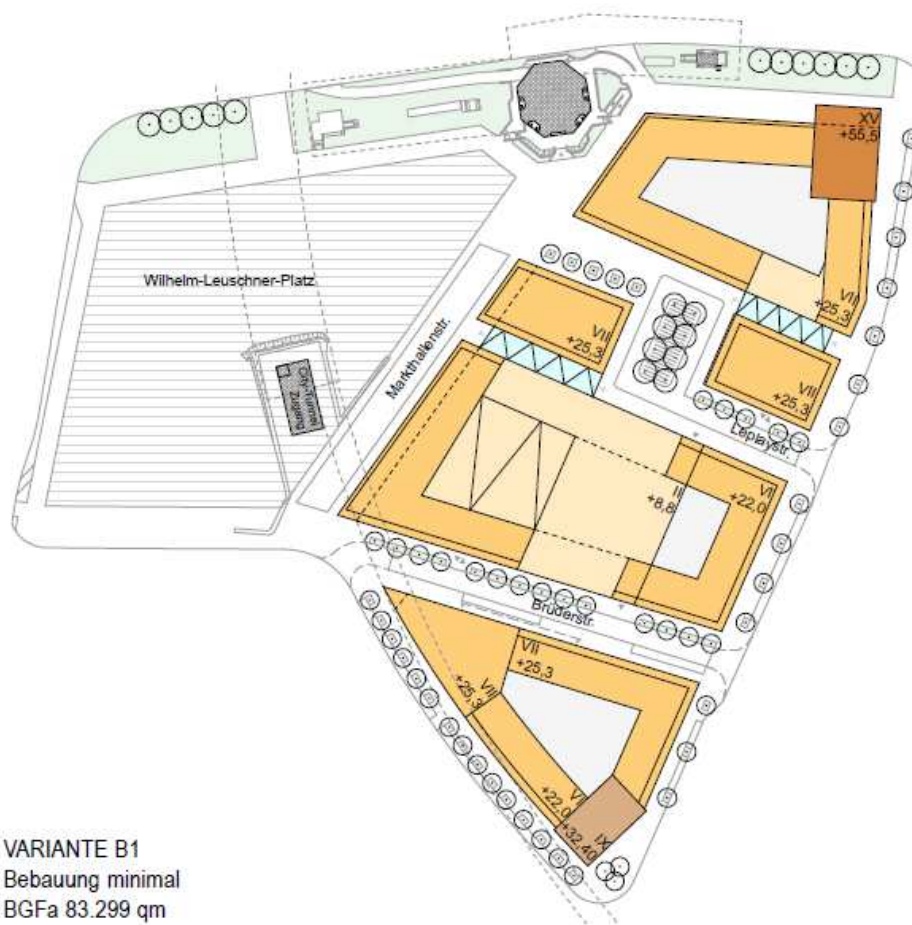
Lageplan Quelle: Masterplanung PWB Pelčák & Wolf Architekten und GRUNWALD & GRUNWALD
